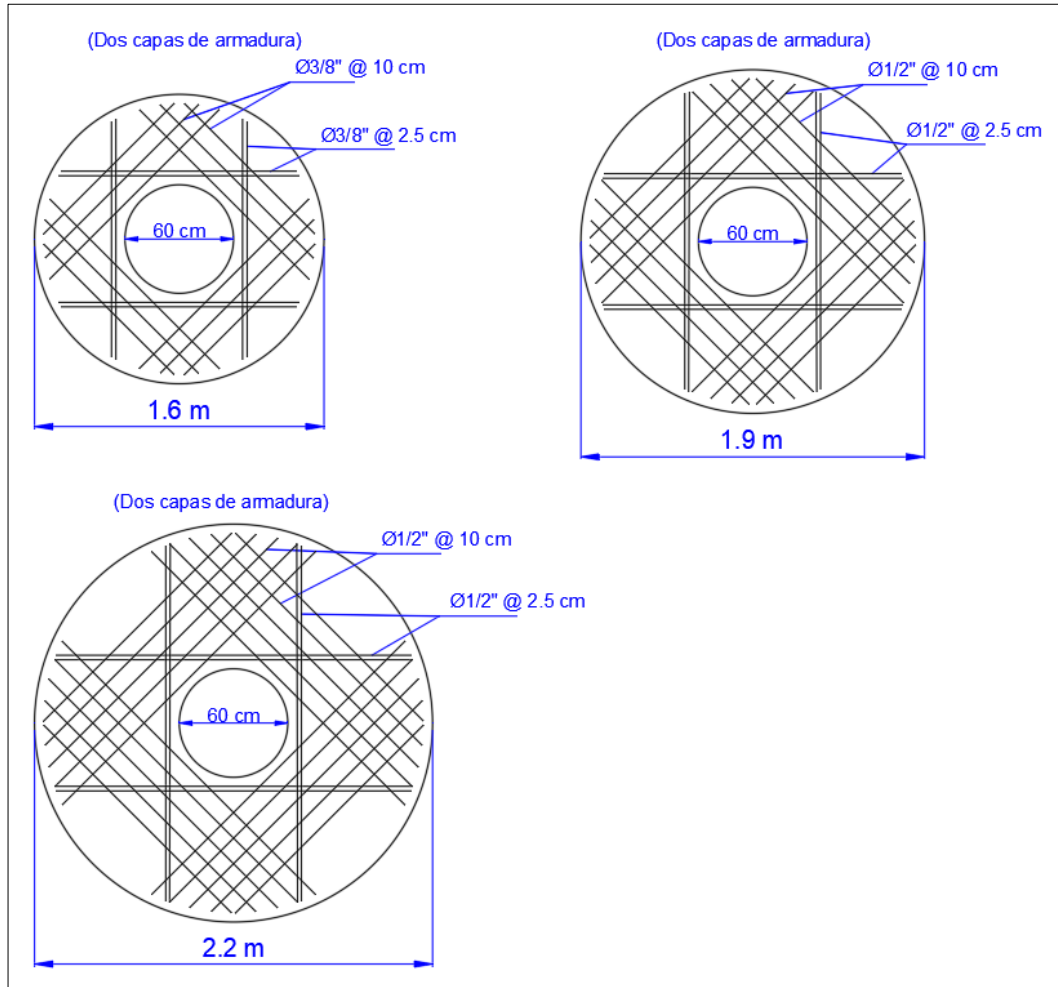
Disposición mínima de cada capa de armadura de la losa superior según diámetro de la losa.
